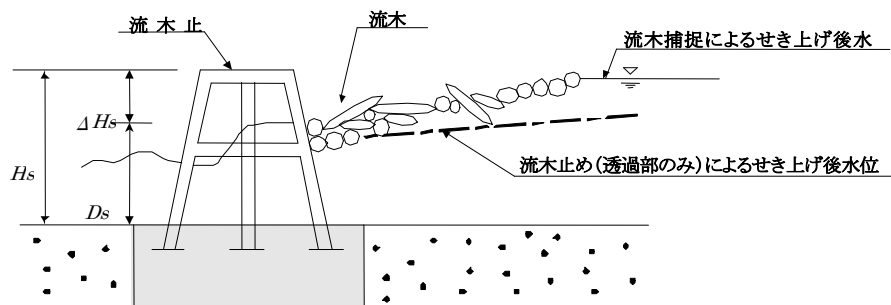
掃流区間に設置する流木捕捉工の透過部の高さ (H_s) の模式図
